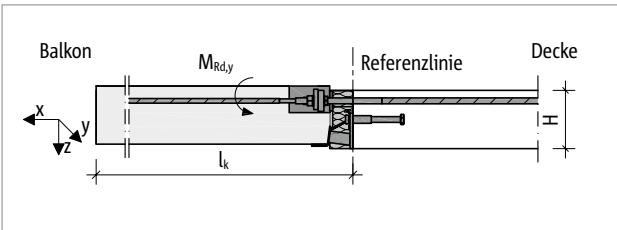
Schöck Isokorb® IQ Typ K-B: Statisches System
